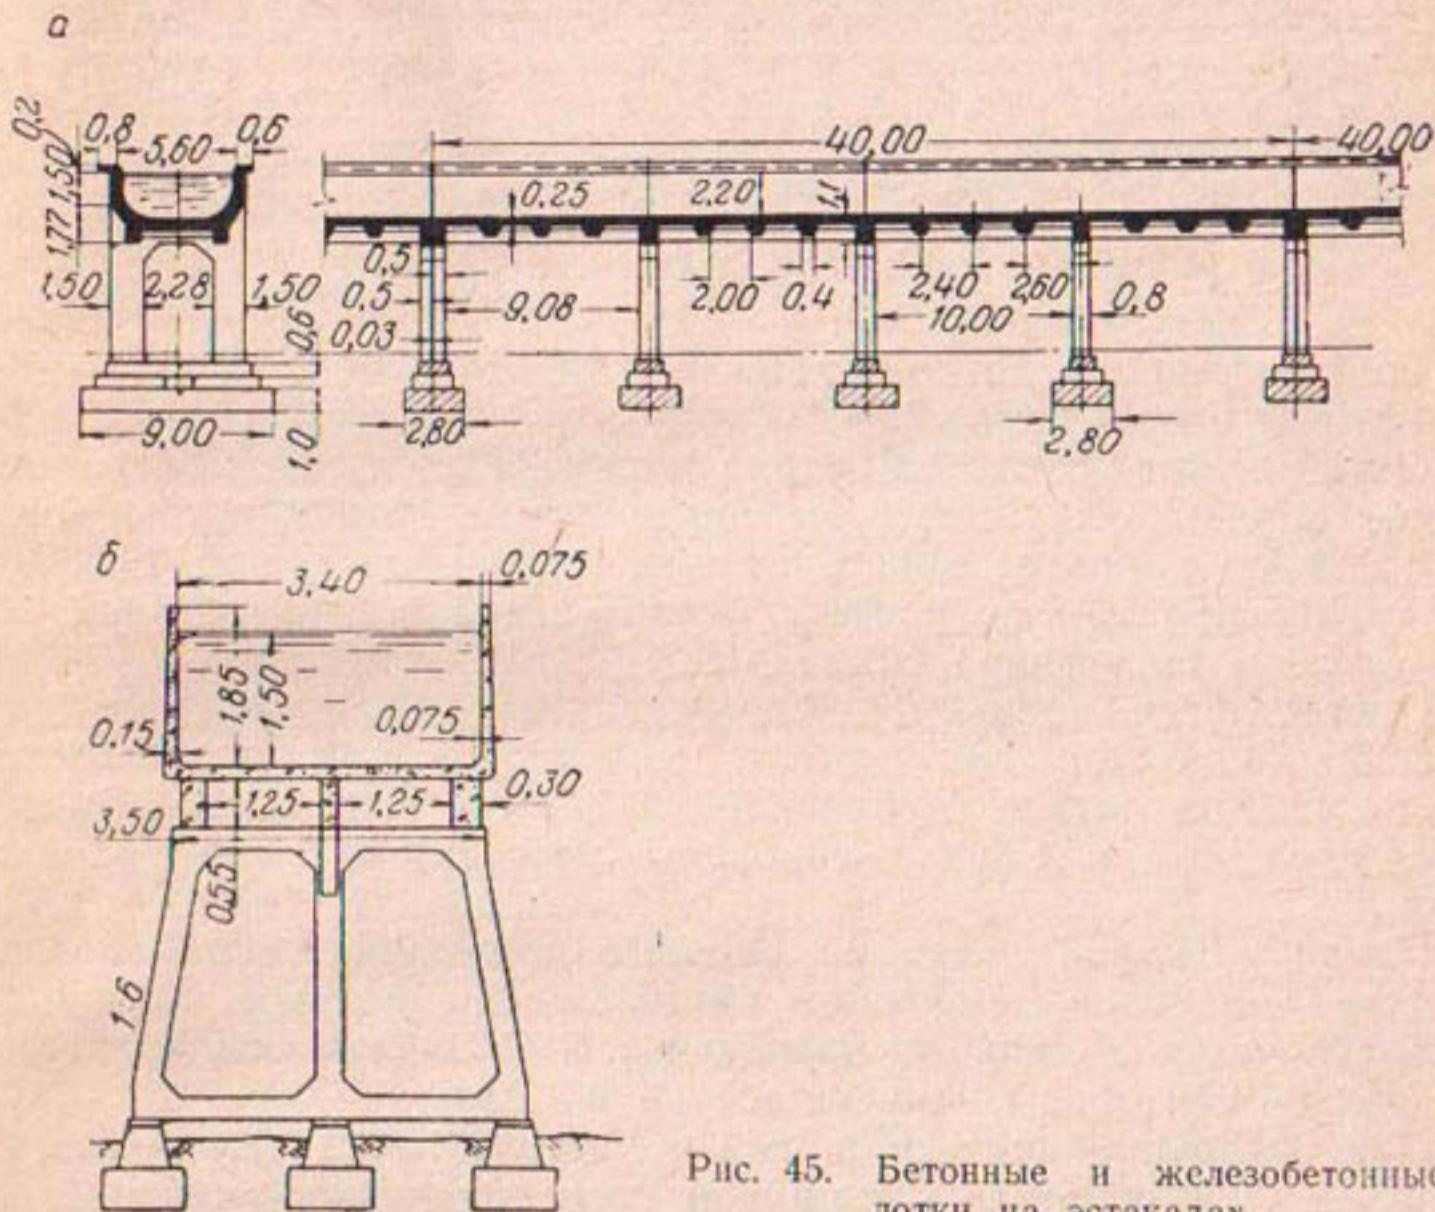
Бетонные и железобетонные лотки на эстакадах.
